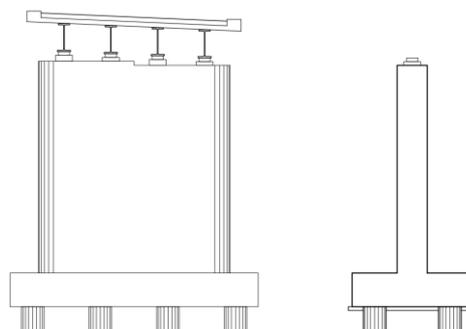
Sezione Strutturale Tipo del Viadotto
